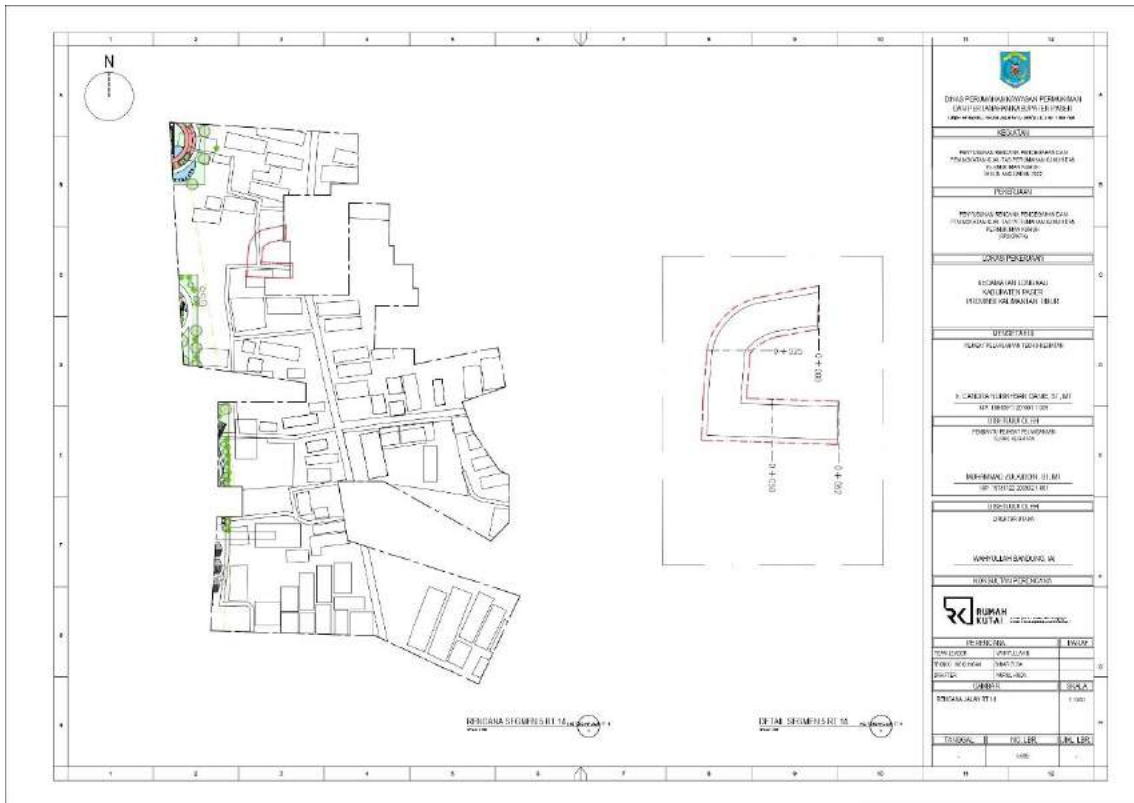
84 Konsep Recana Jalan Segmen 2 RT.14
